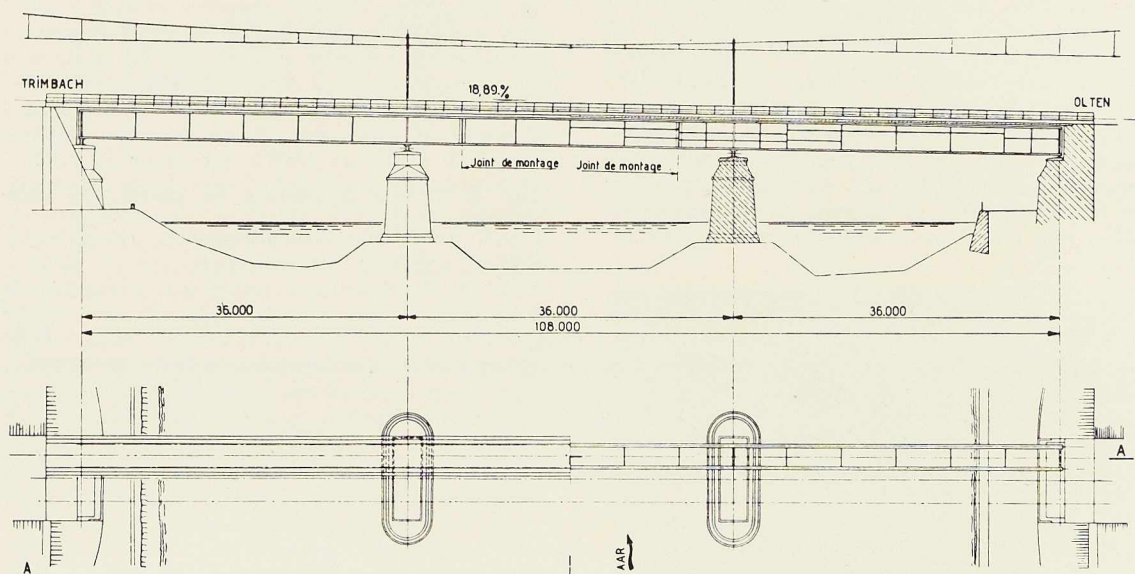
Elévation et vue en plan du nouveau pont métallique soudé, sur l'Aar, à Olten (Suisse).
